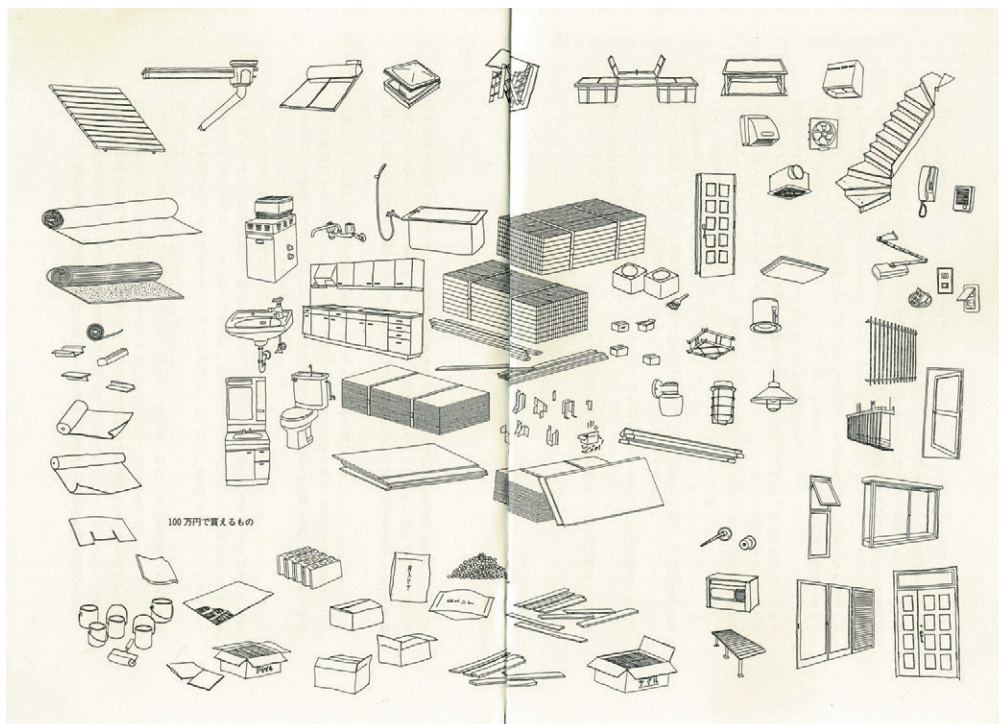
Osamu Ishiyama. Plano enviado a Estados Unidos para la construcción de la primera vivienda enviada en contenedor. Fuente: *Shinkenchiku*.
